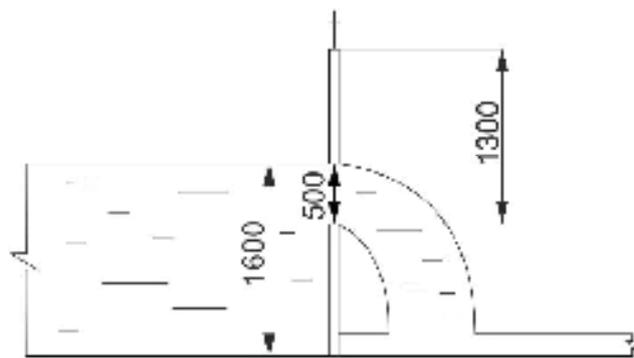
Расчетная схема для расчета водопропускного отверстия на ПК 65 магистрального канала малой Балаковской оросительной системы (МБОС)
